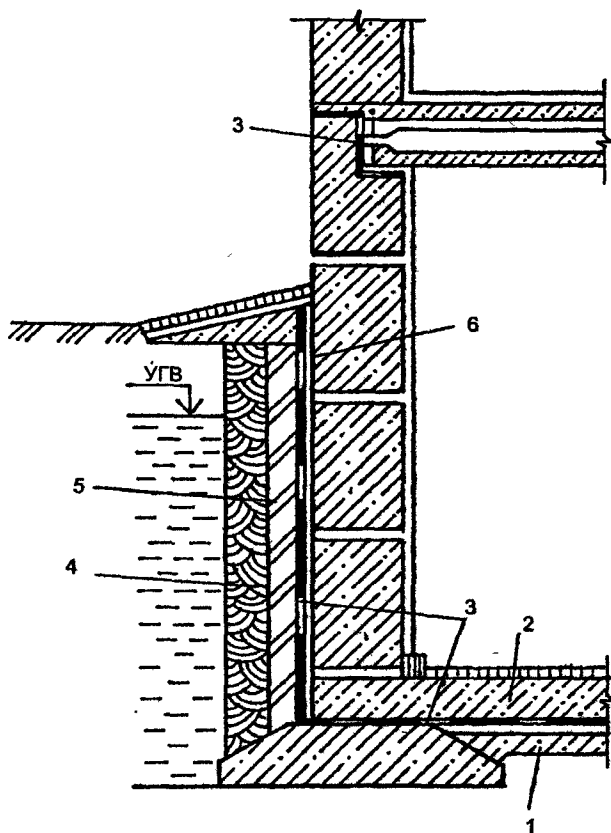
Гидроизоляция ленточного фундамента в здании с подвалом:
